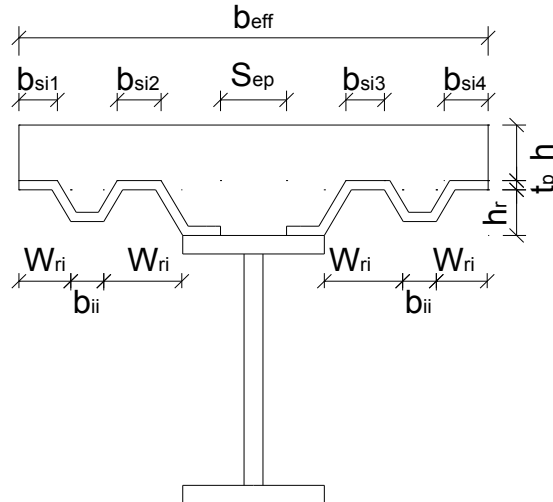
Sección transversal real. Viga paralela a las nervaduras de la lámina de acero.
